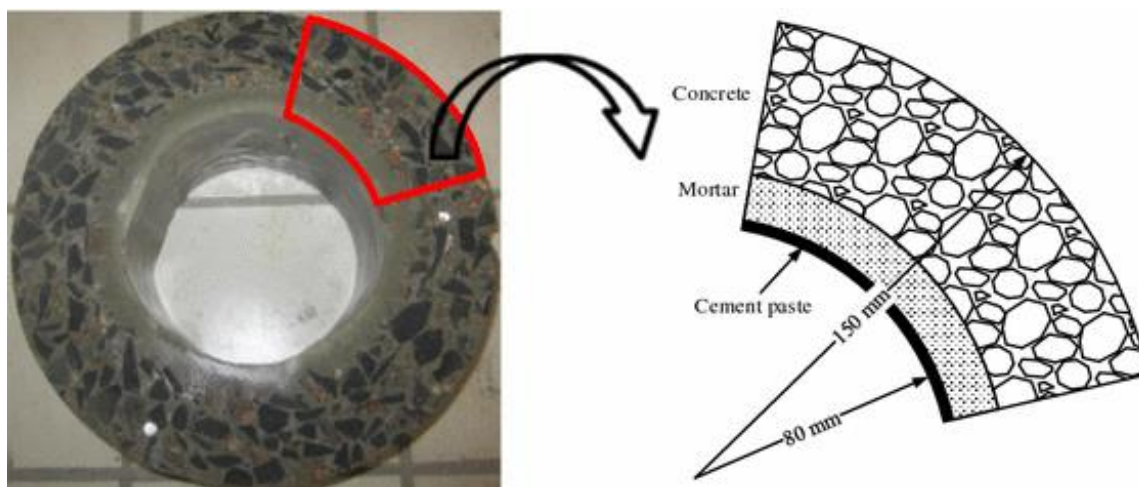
Corte transversal de pilotes huecos de concreto reforzado. (Yue et al., 2016)
